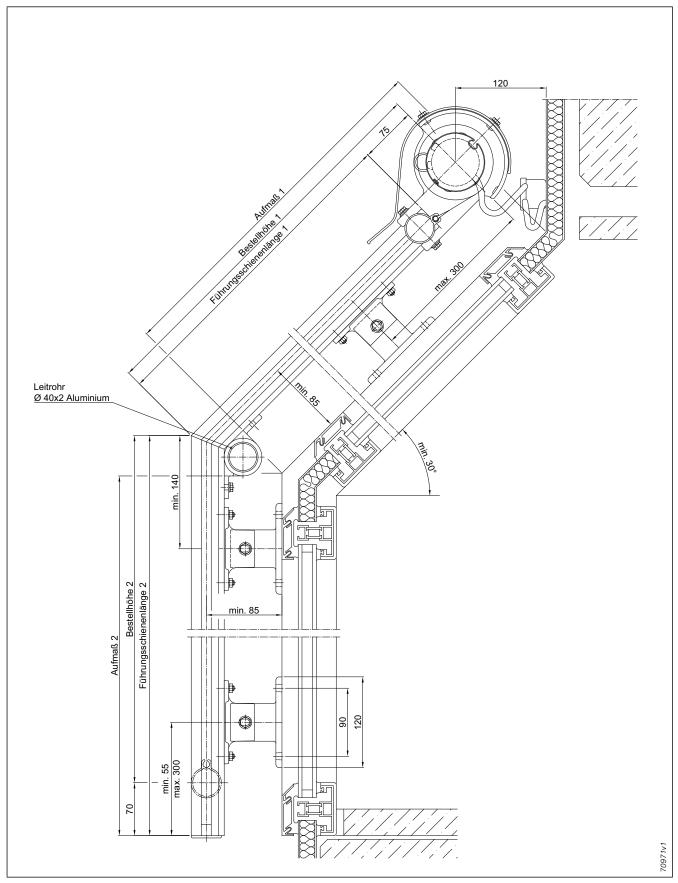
Fassaden-Markise 203 mit Halbrundblende Typ 2.3 um 40° gedreht
